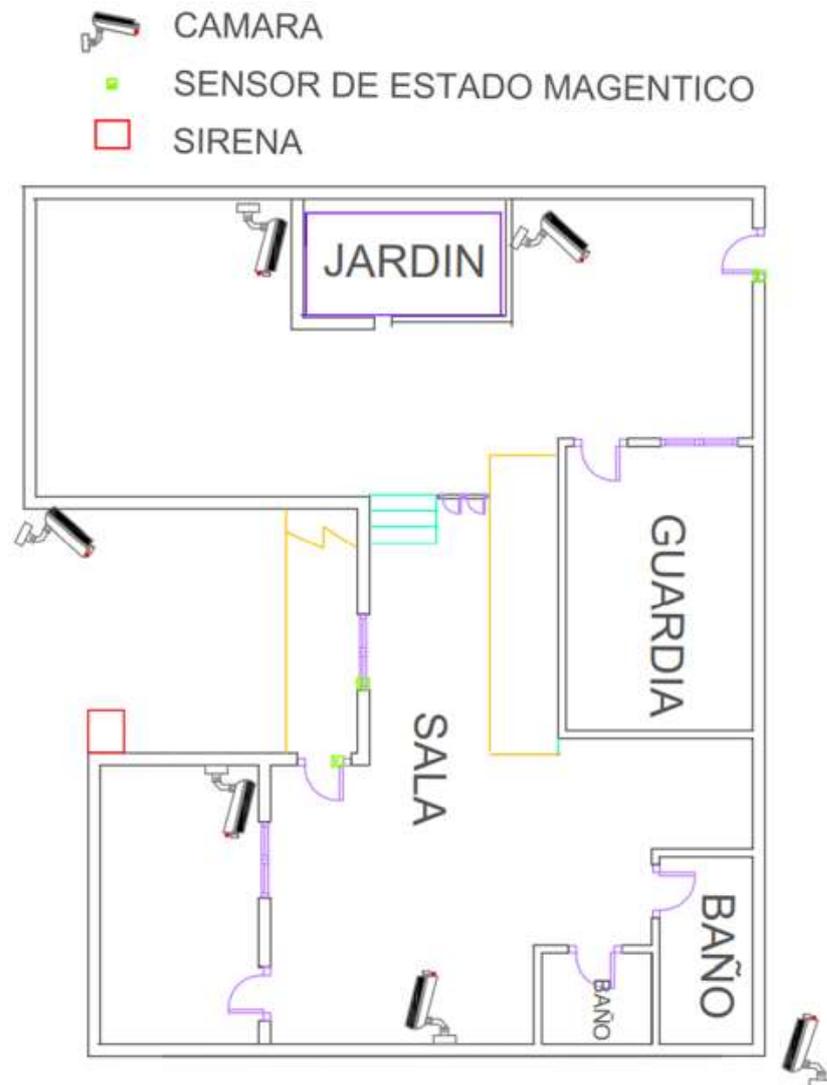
Distribución de los sensores en la planta 1 del sistema de seguridad
